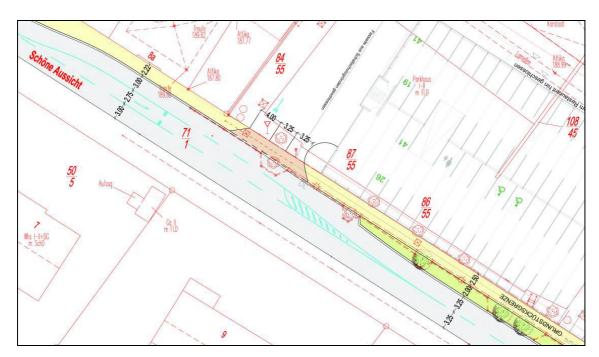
Planung zu baulichen Änderungen in der Schönen Aussicht<sup>10</sup>
